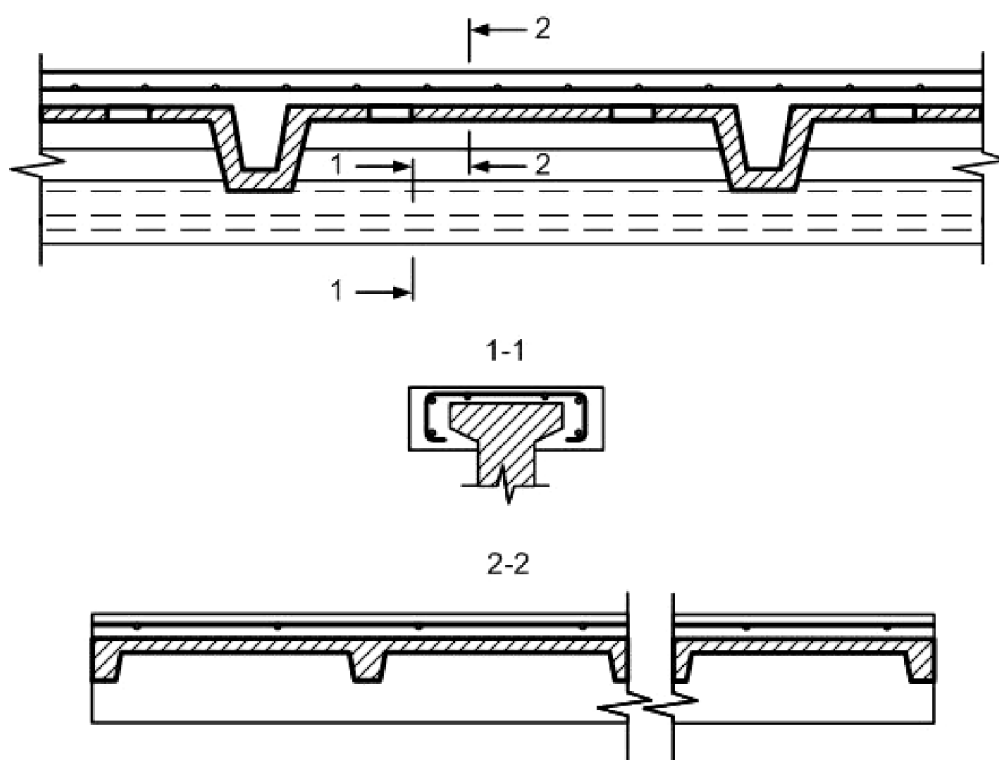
Схеми підсилення балок та плит перекриття наросуванням
